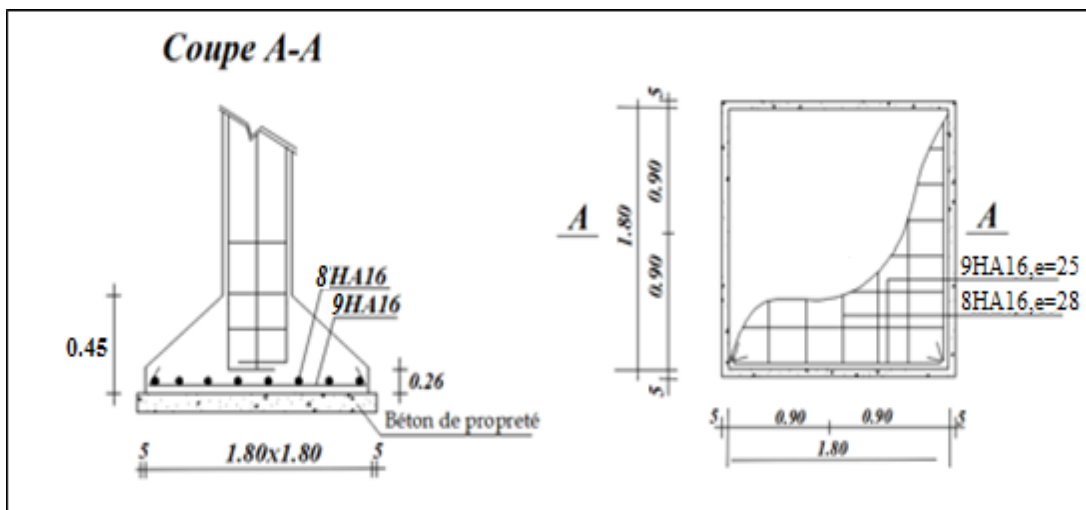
Exemple de ferrailage d'une semelle de rive sous poteau.
